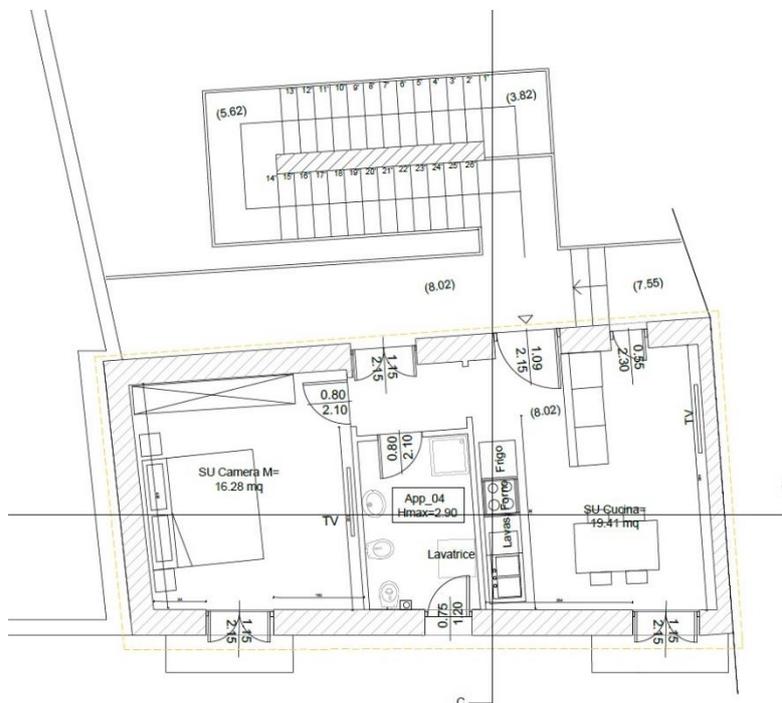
Progetto architettonico edifici D/E (pianta piano secondo)
